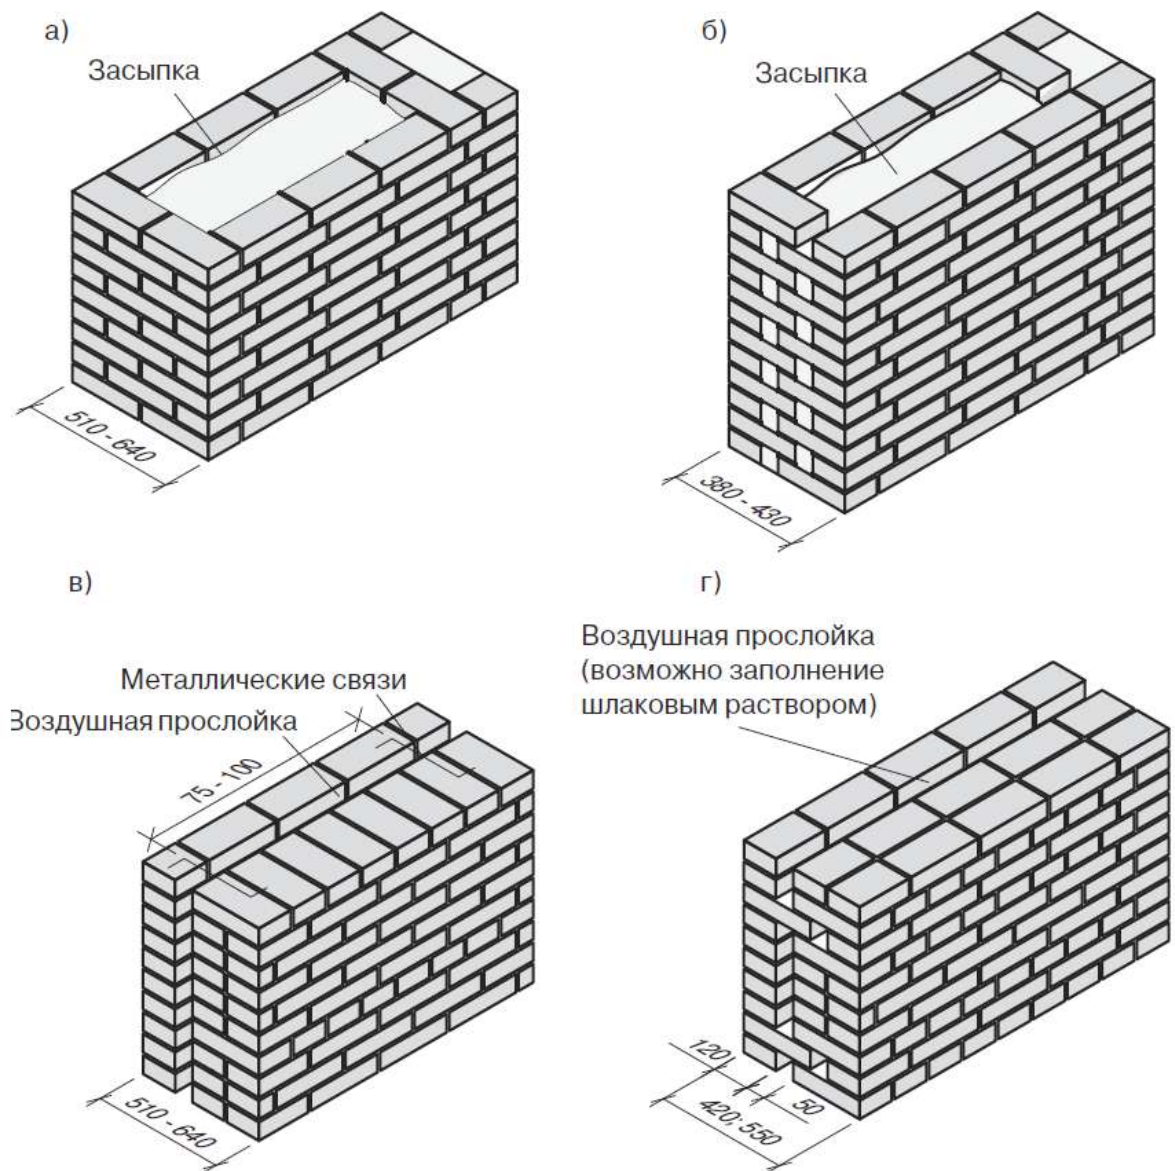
Стены : а, б – из колодцевой кладки; а, б, в – на гибких связях;
